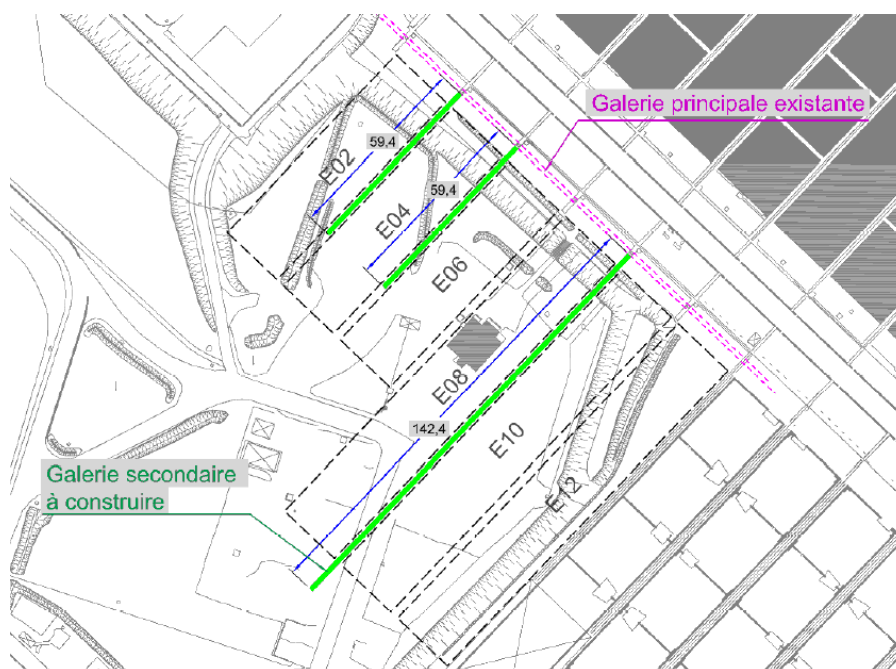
Plan d'implantation des nouvelles galeries secondaires
